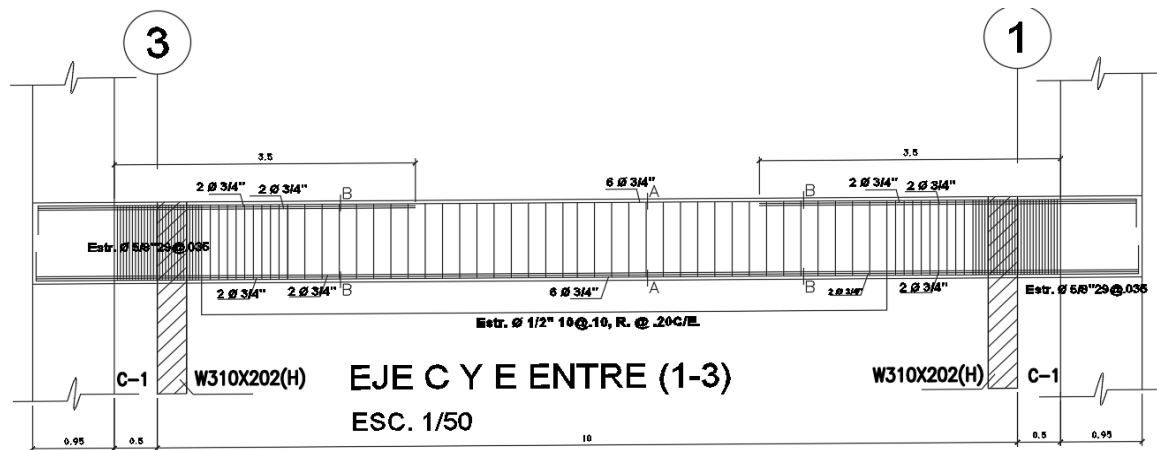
Detalle del acero de refuerzo de la viga interior del 1° nivel de los pórticos, comprendidos desde el eje 1 hasta el eje 3.
